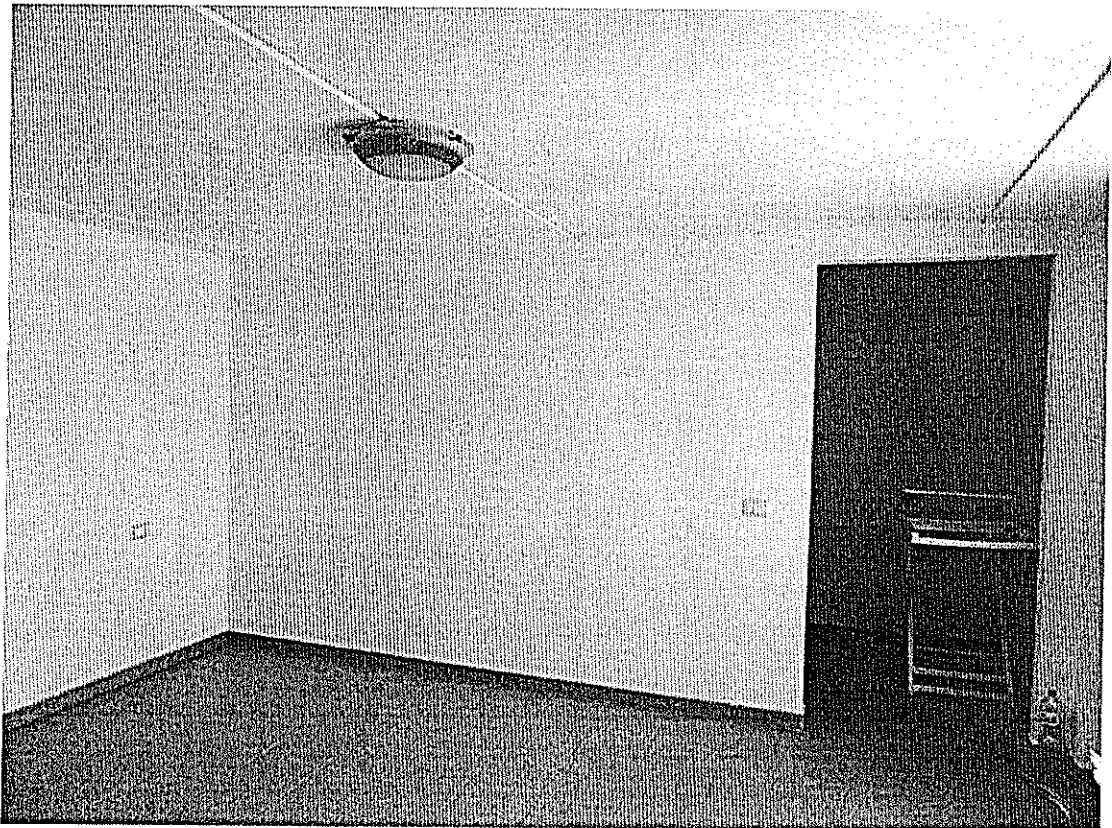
Locale tecnologico del primo corpo di fabbrica – piano secondo.
